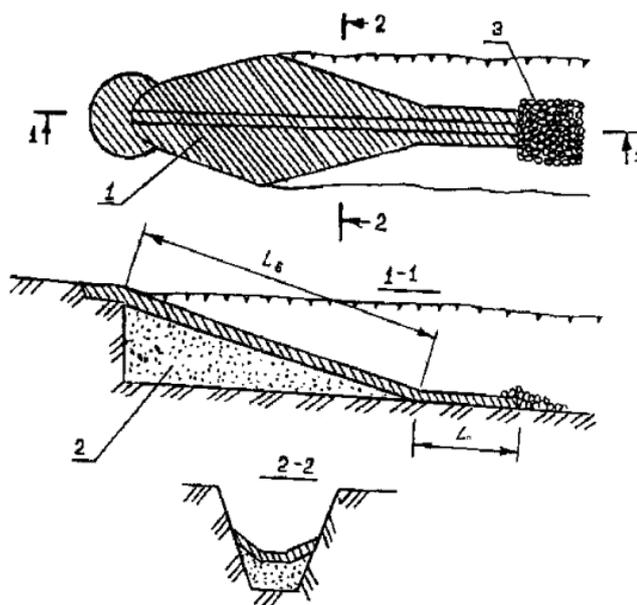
Конструкция быстротока из закрепленного грунта в вершине оврага: 1 - закрепленный грунт; 2 - насыпной незакрепленный грунт; 3 – каменная наброска
